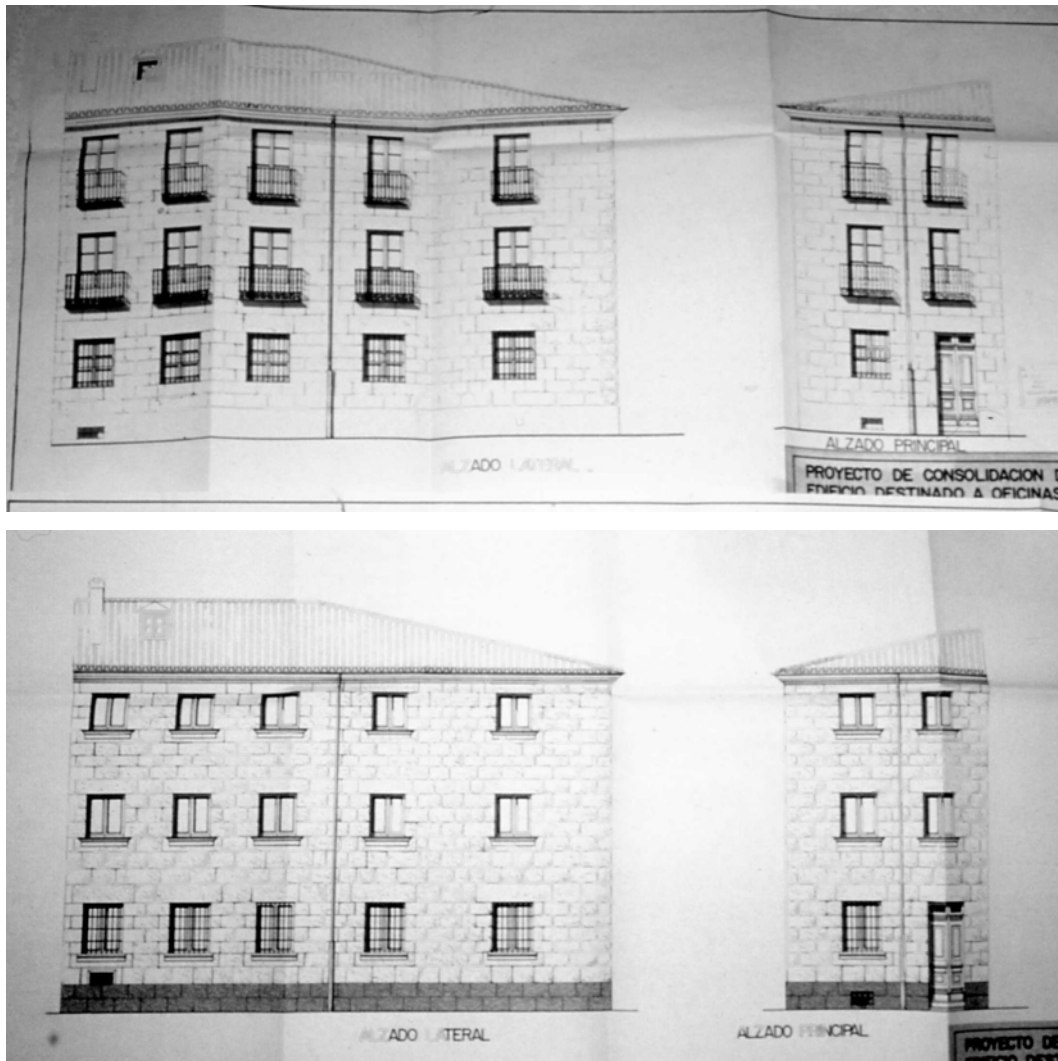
Casa de los Gatos: fachadas (estado original y reformado), por Francisco García Gómez, en 1988.
